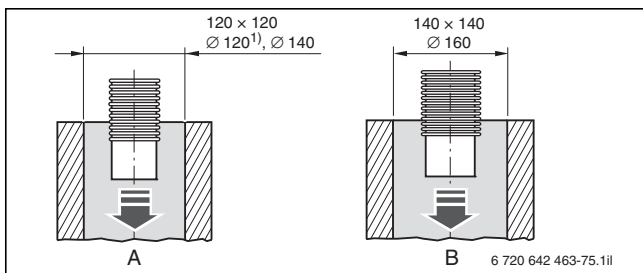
Mindestmaße des Schachtquerschnitts für die Montage der flexiblen Abgasleitung (Maße in mm)
